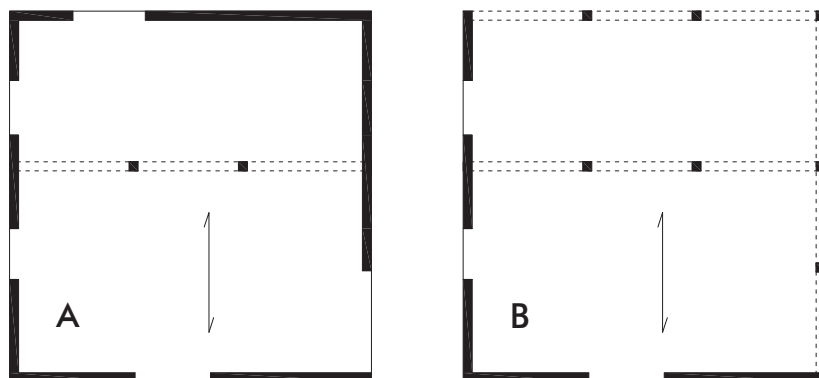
Pianta. A-SI: Il telaio centrale serve solo a portare i carichi verticali facendo da supporto intermedio al solaio. B-NO: Le pareti presenti non sono sufficienti a resistere alle azioni orizzontali, non è ammissibile che i telai partecipino insieme alle pareti alla resistenza alle azioni orizzontali.
